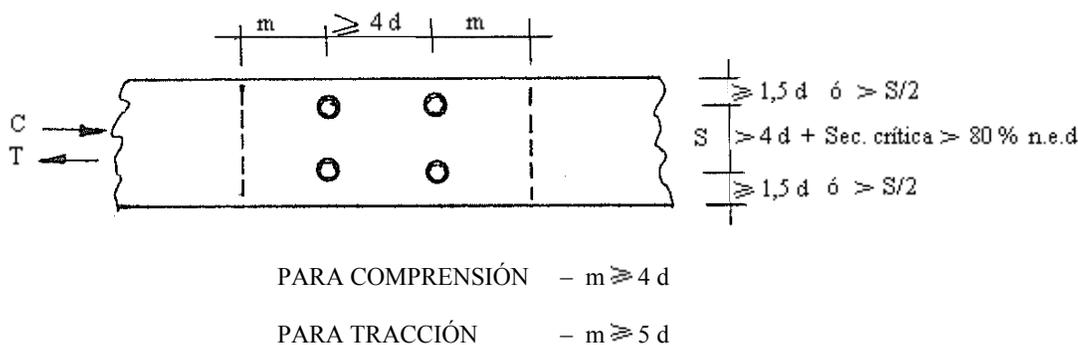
Unión empernada con fuerzas aplicadas paralelas a las fibras
